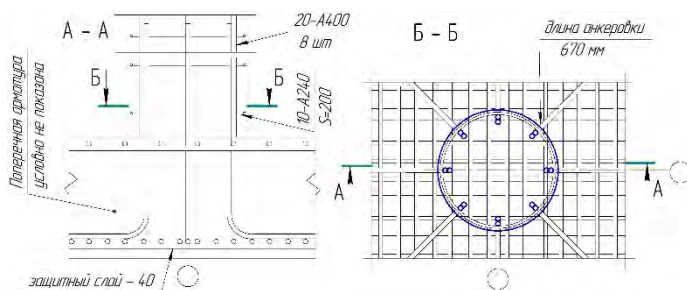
Узел сопряжения колонны круглого сечения с фундаментной плитой
